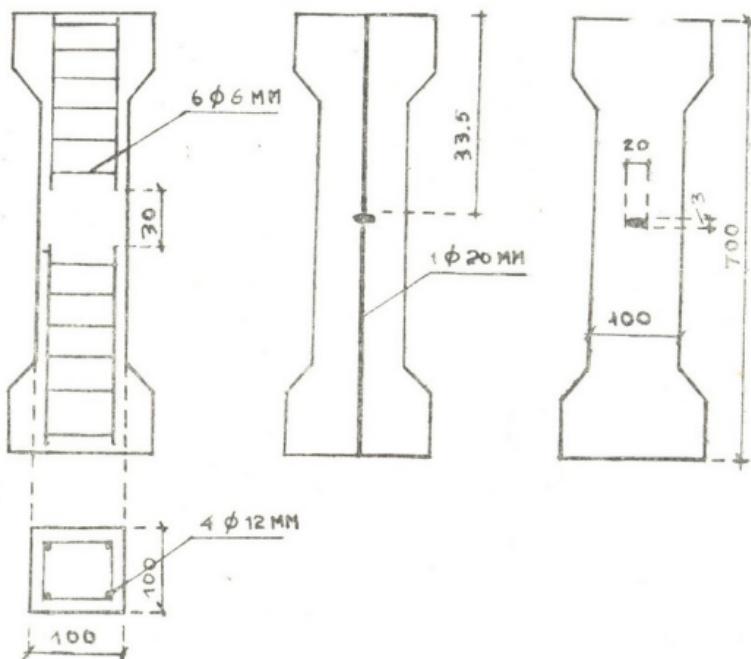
Виды конструкций испытанных армированных и неармированных опытных образцов-восьмерок
